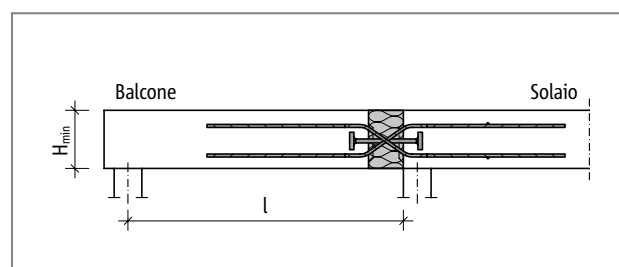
Schöck Isokorb® tipo QPXT+QPXT: sistema statico
